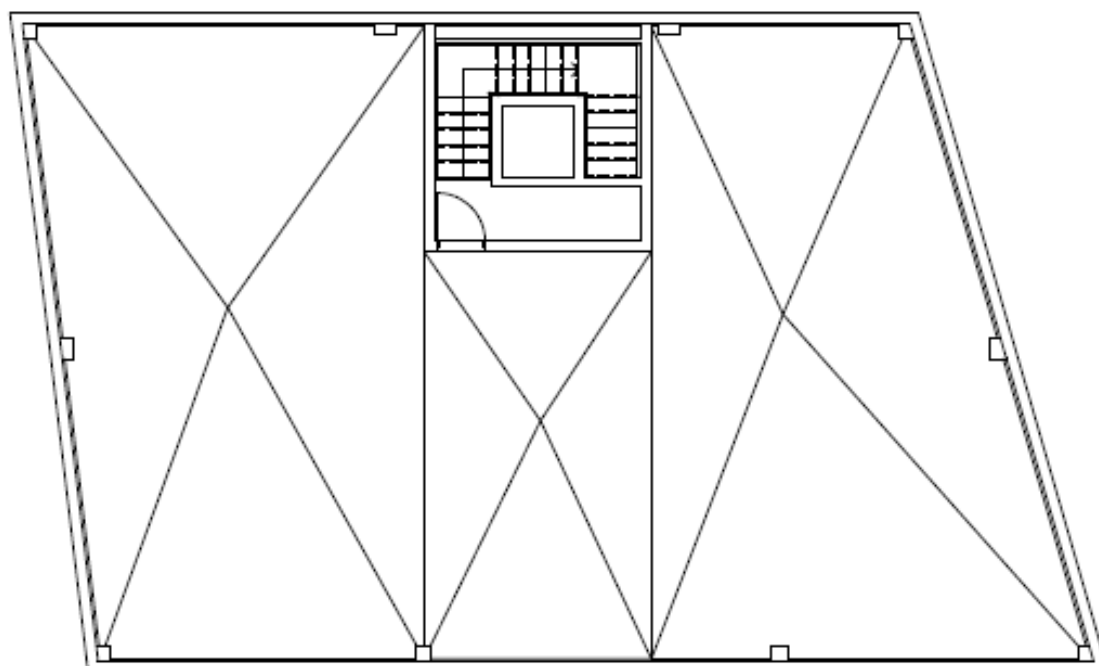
Planta cubierta. Fuente: Propia (2019)
